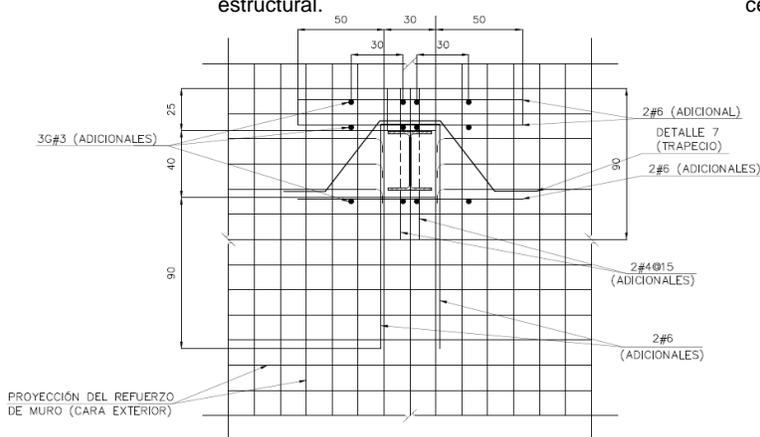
Corte C-C. Espacios de apoyo para vigas cerrojo en colados subsiguientes.
